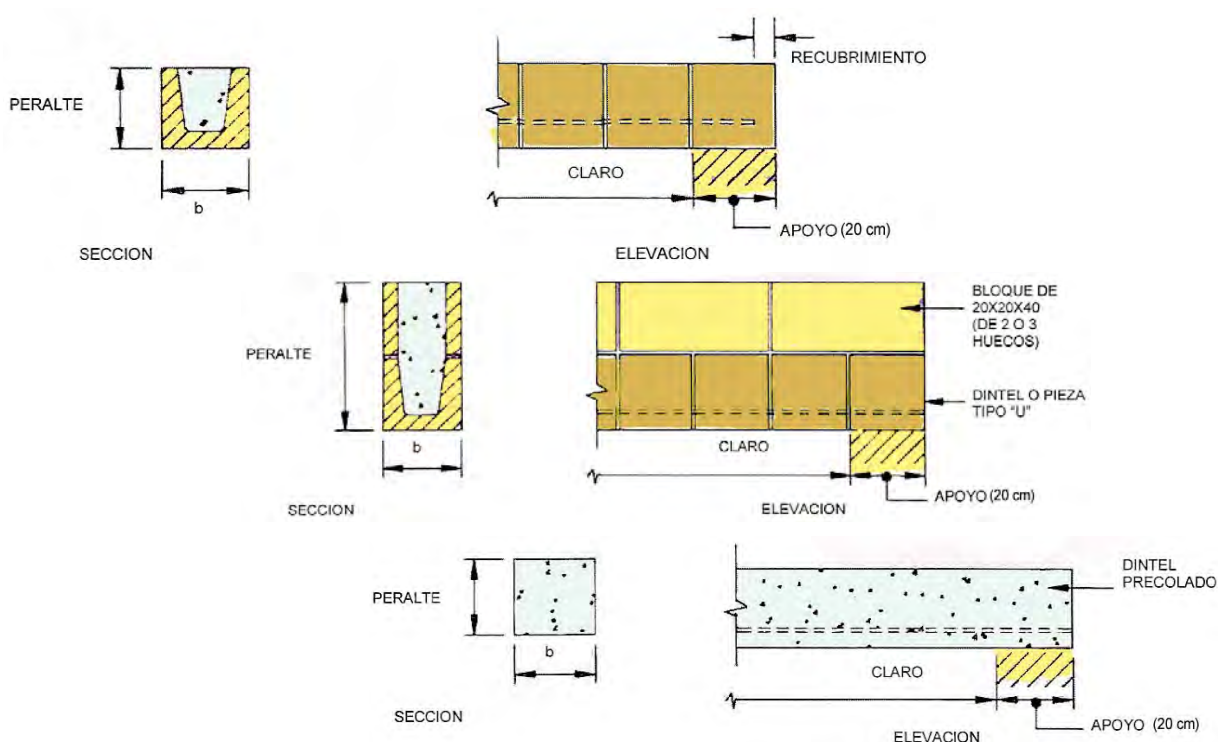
DETALLES CONSTRUCTIVOS DE DINTELES SIMPLEMENTE APOYADOS DE CONCRETO ARMADO Y DE PIEZAS DE MAMPOSTERÍA Y COLADO COMPLEMENTARIO
